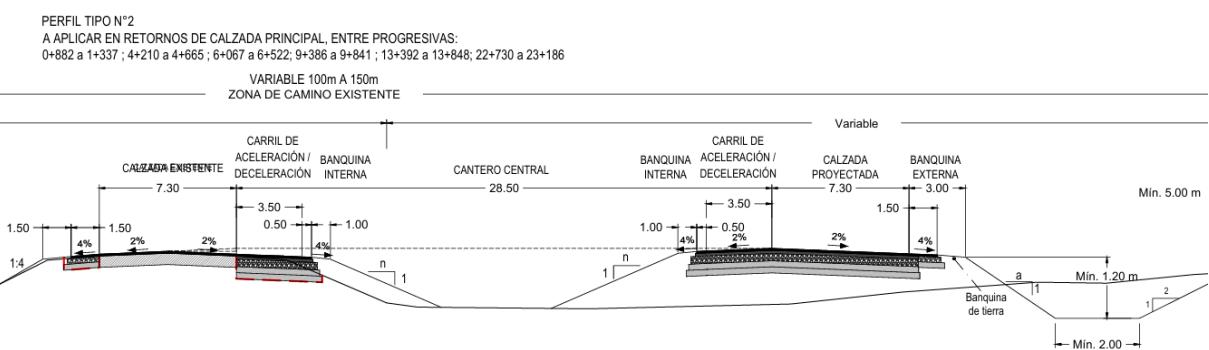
Perfil tipo de obra básica de proyecto en retornos
